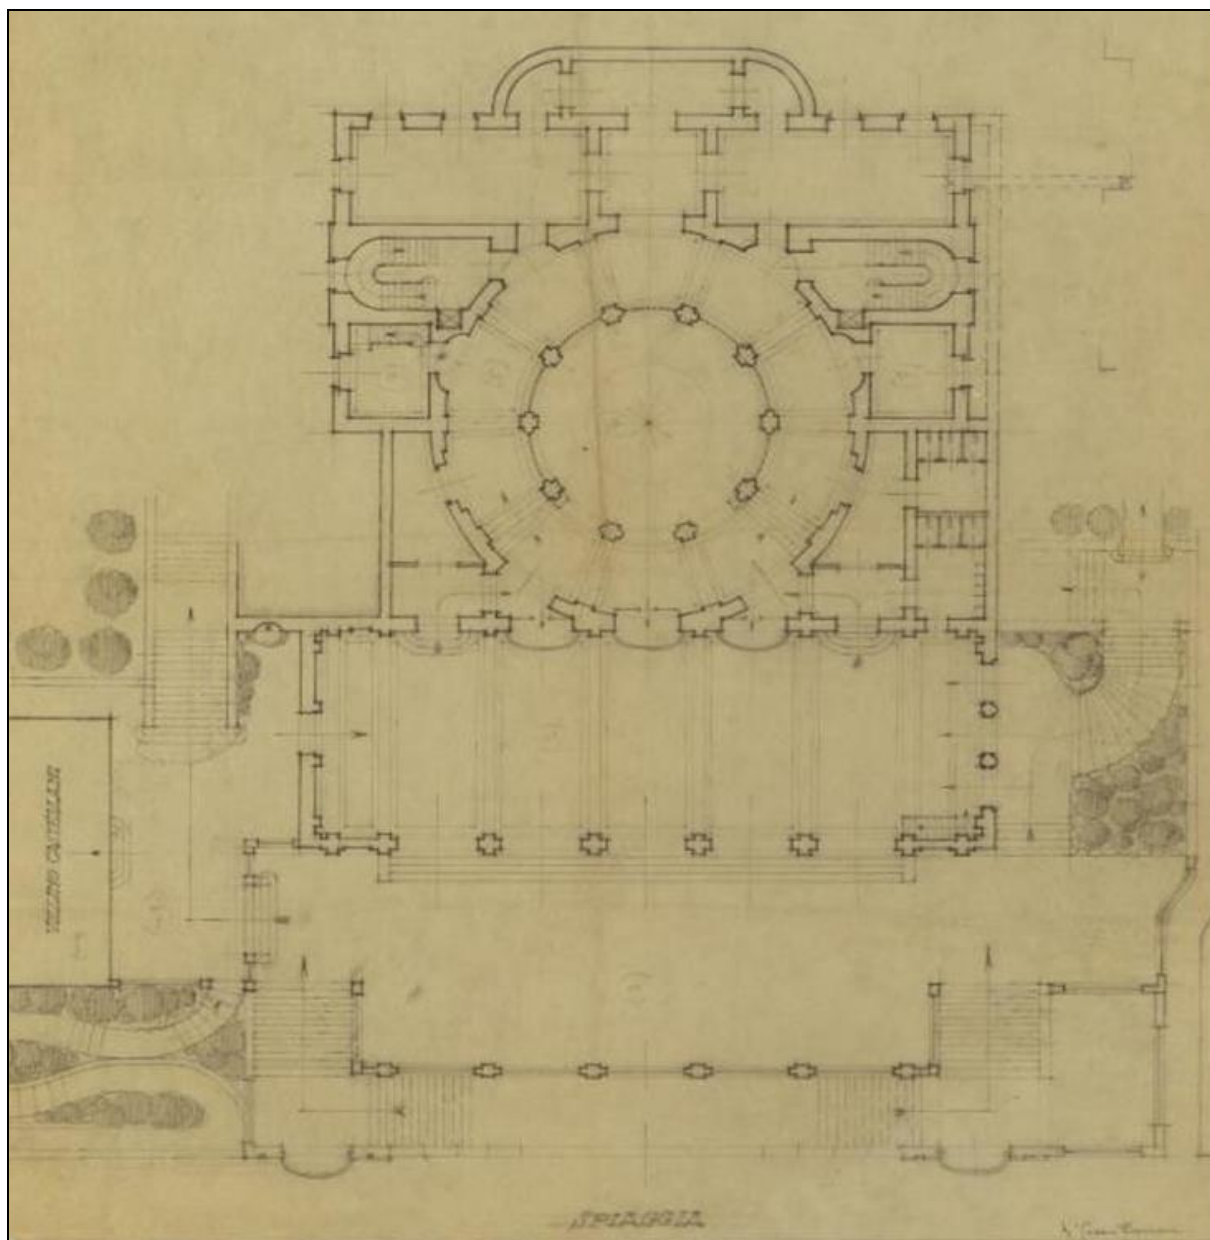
Piante del complesso – Archivio di Stato di Terni (Fondo Bazzani)
